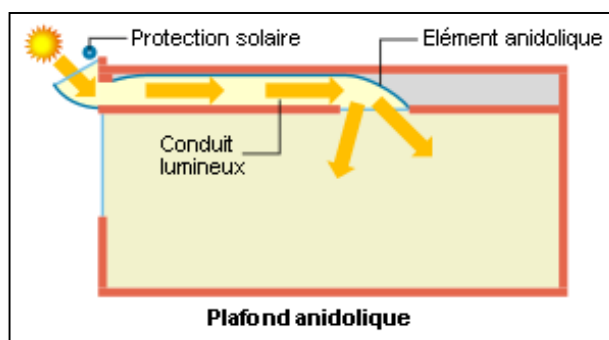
Impact d'un plafond anidolique sur la pénétration solaire
